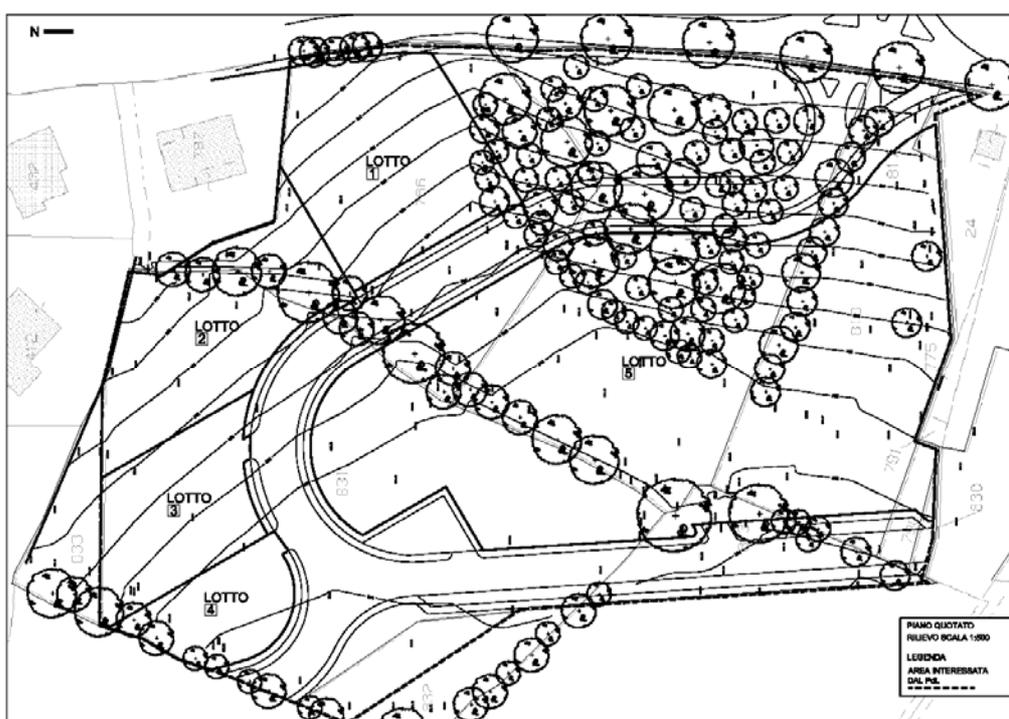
Piano quotato attuale e sovrapposizione con il progetto di piano ottobre 2008
